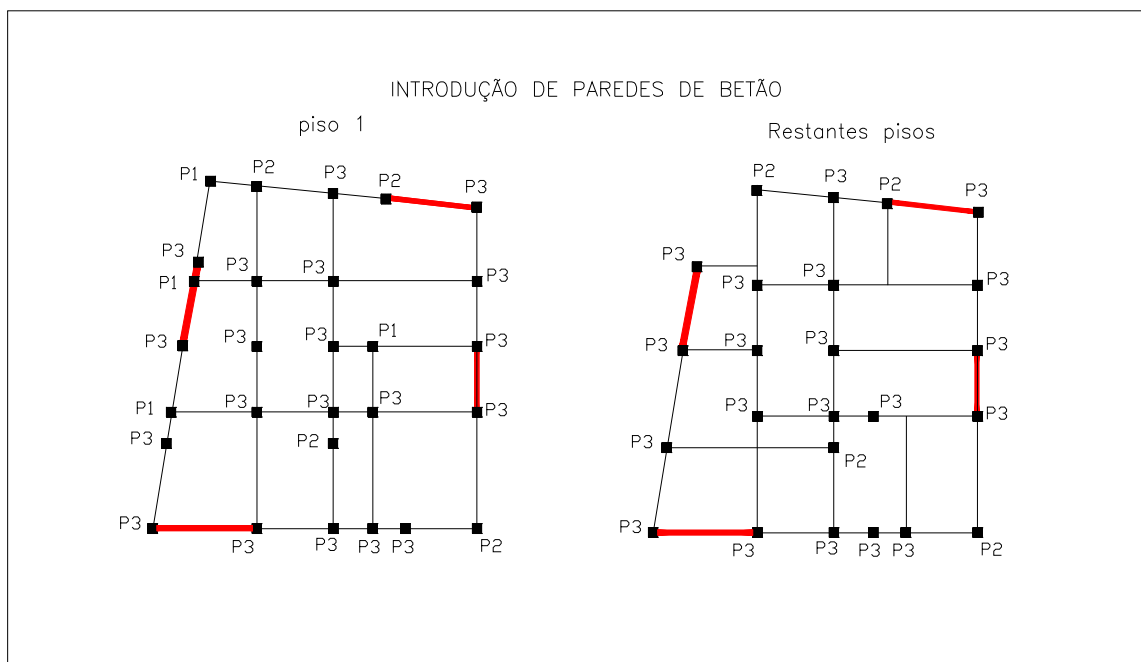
Planta estrutural do edifício reforçado com introdução de paredes de betão.
